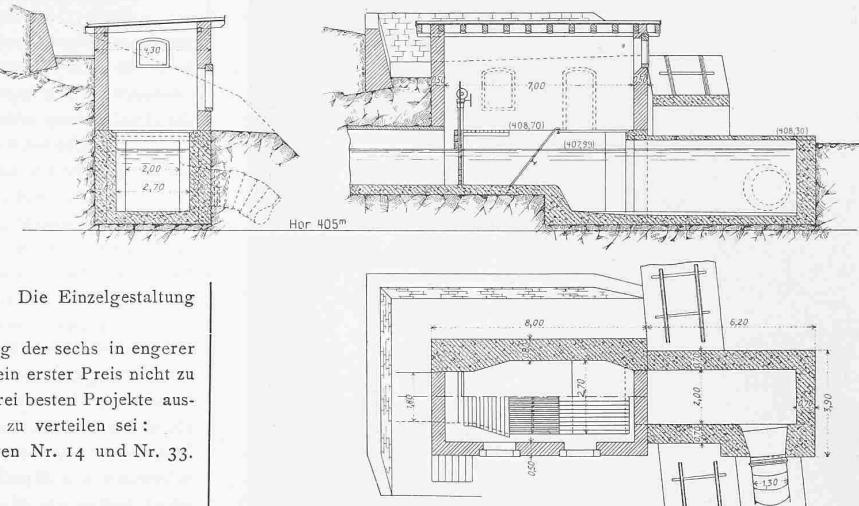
Grundriss, Quer- und Längsschnitt vom Wasserschloss.
